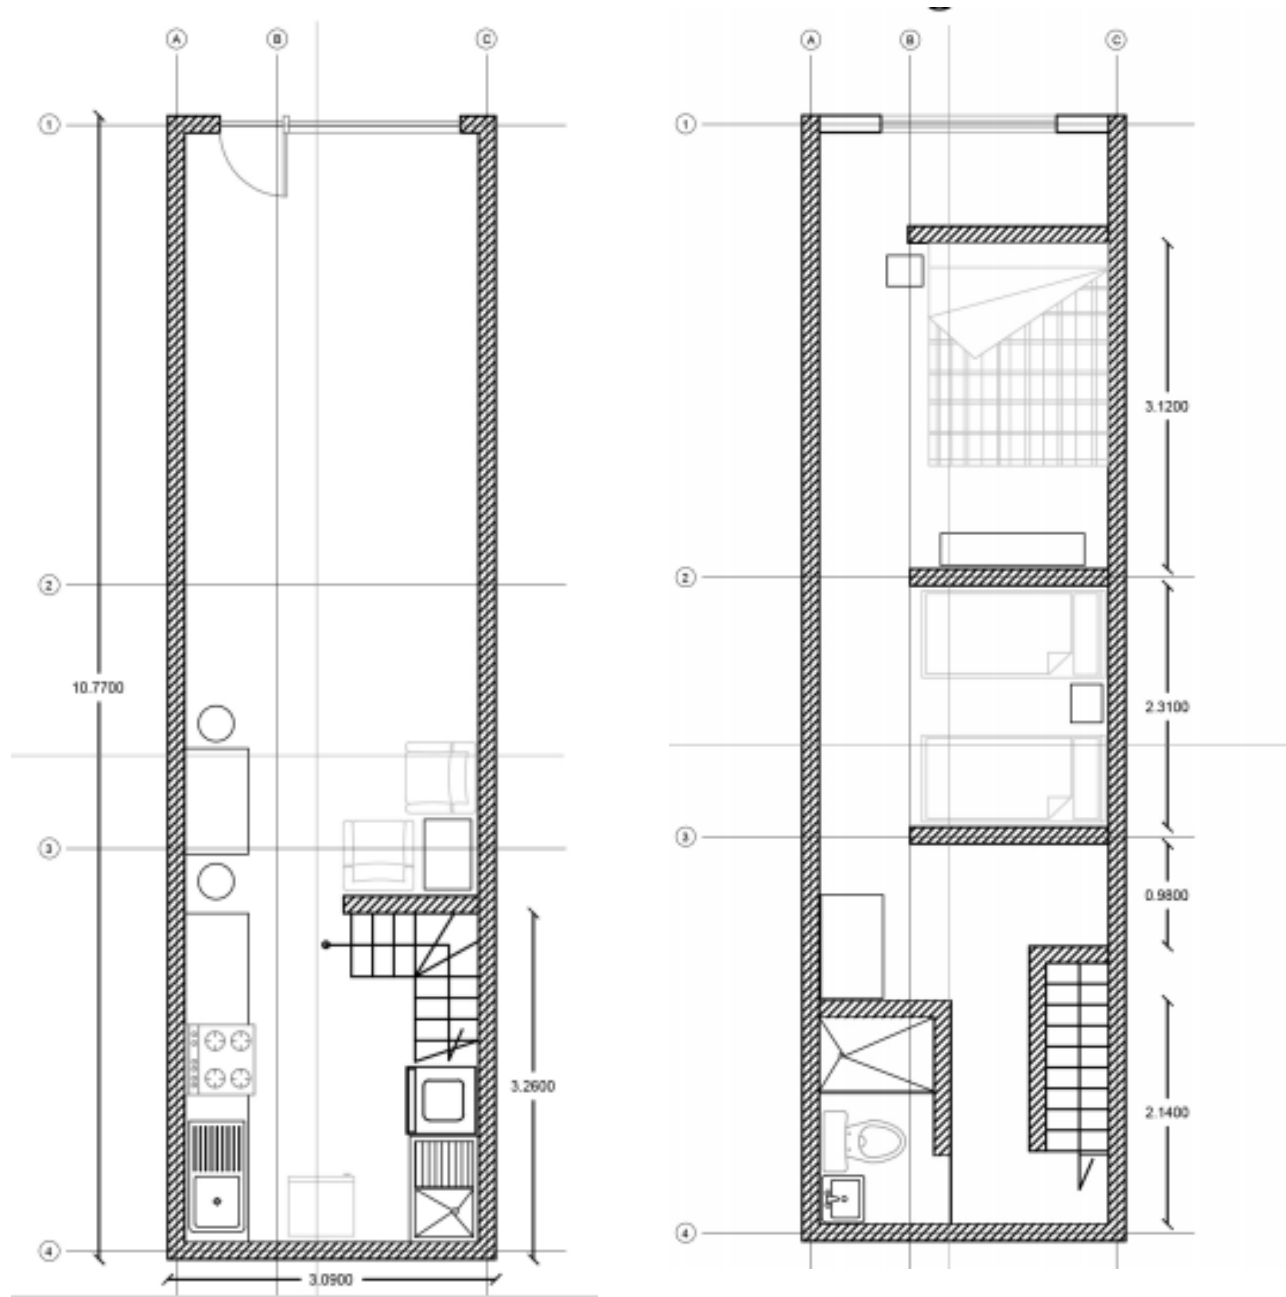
Proyecto vivienda popular, planta arquitectónica. Levantamiento 2015.
